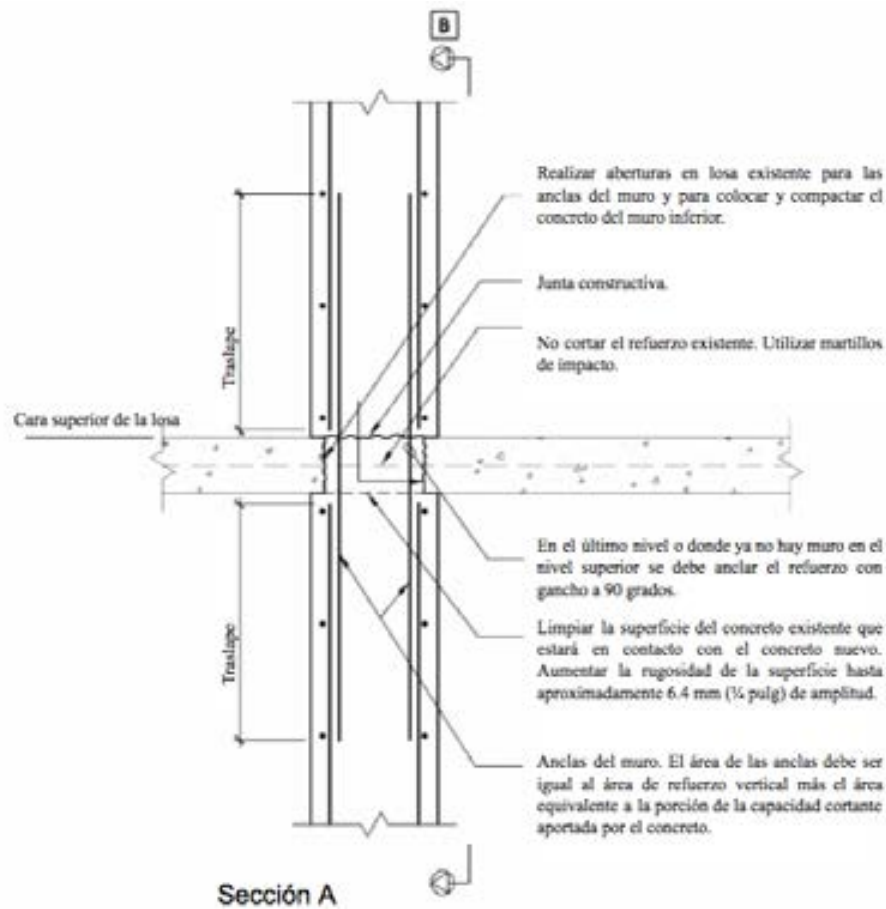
Conexión de un muro en edificios con losas macizas (FEMA 547)
